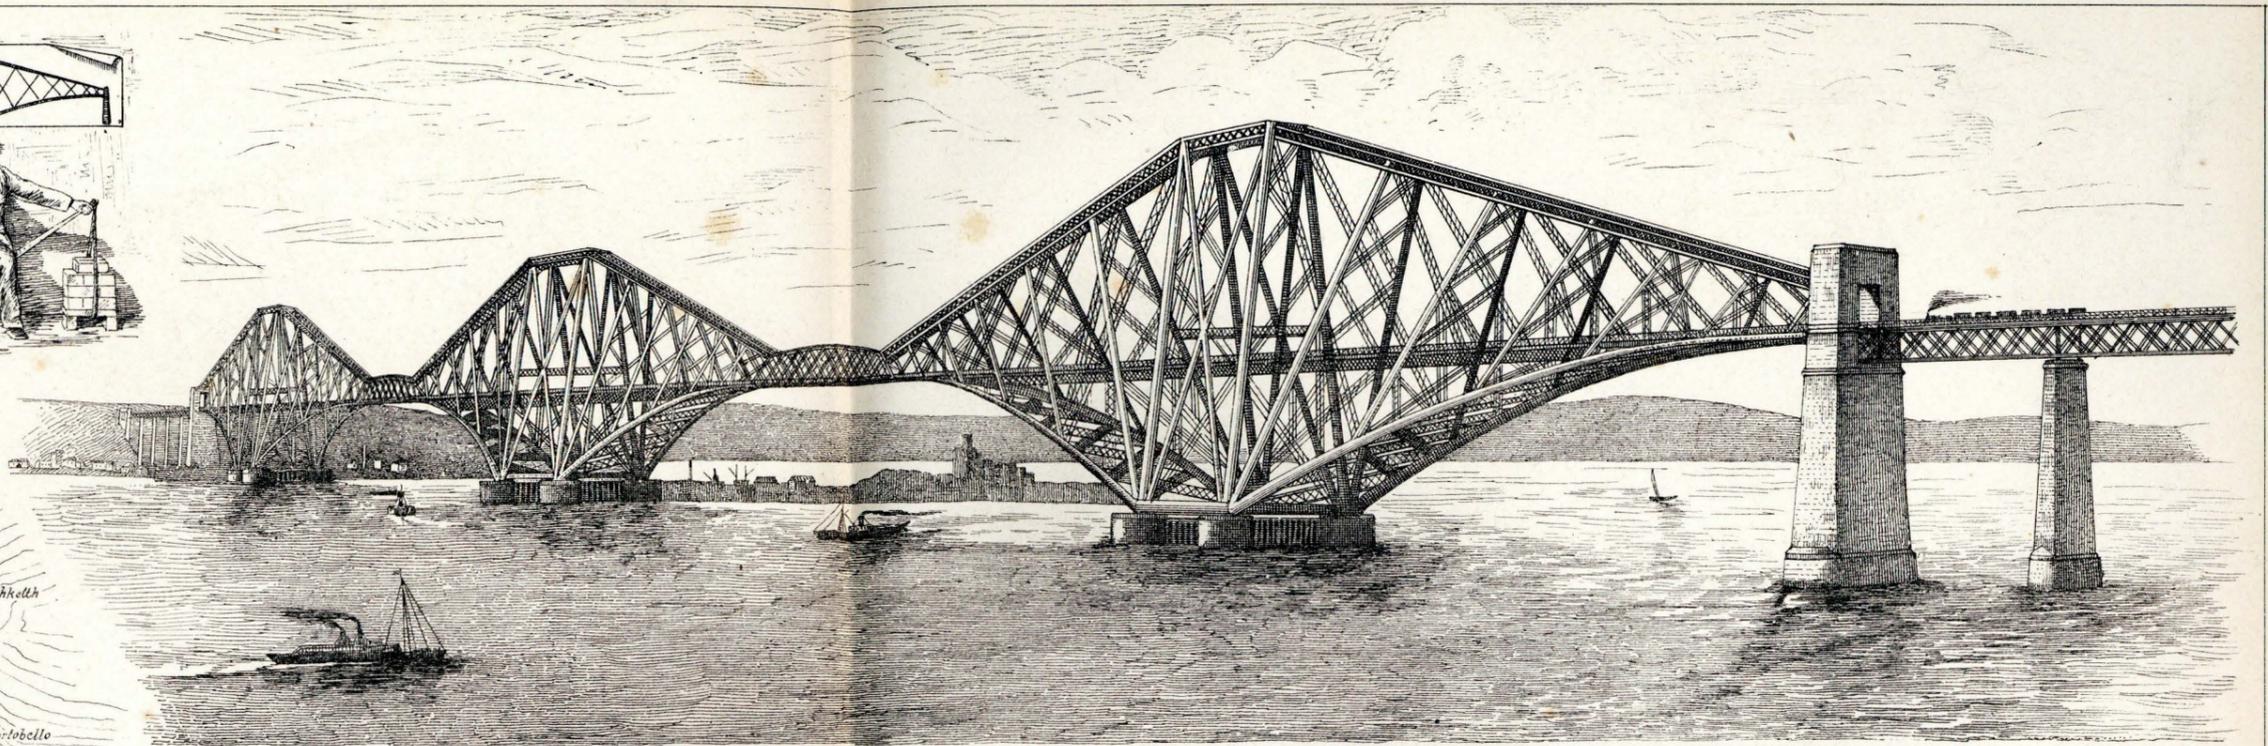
Veduta prospettica dalla sponda South Queensferry.
